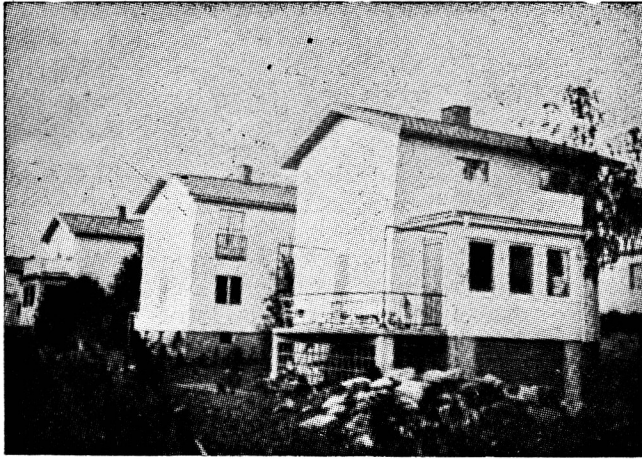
Las formas prefabricadas de construcción con madera se han desarrollado comercialmente en América y en Suecia, y los diseños son armoniosos.
